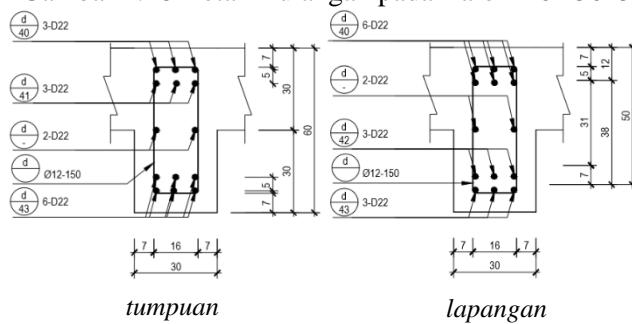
Detail Tulangan pada Balok B4 250x500
